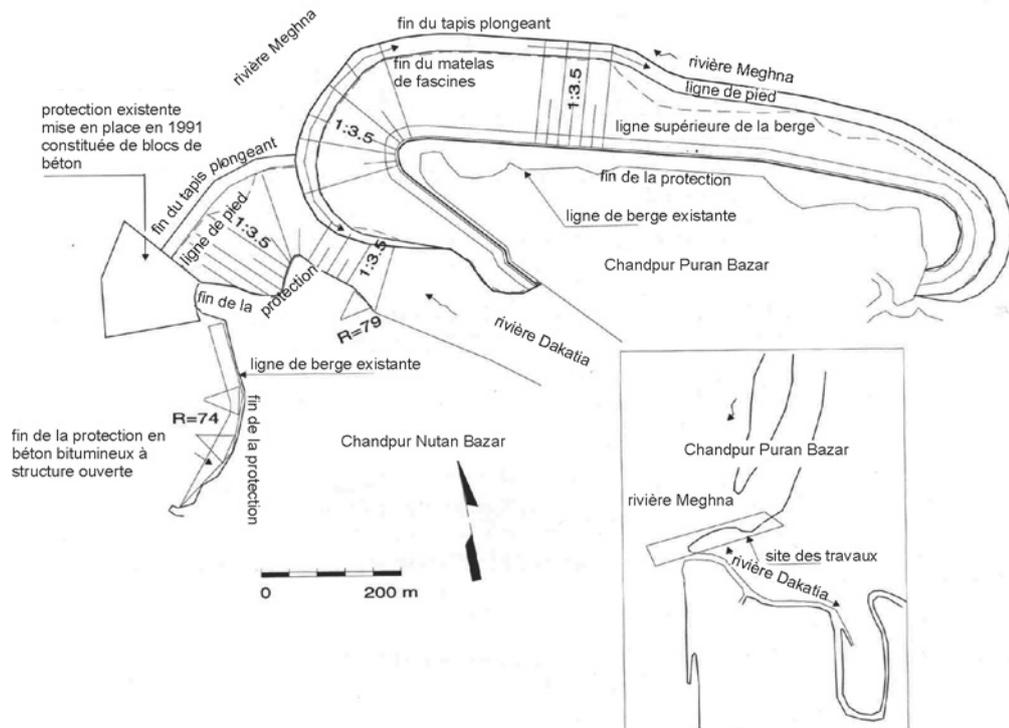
Exemple d'ensemble d'ouvrages potentiels sur une rivière en tresse (source : Royal Haskoning)
